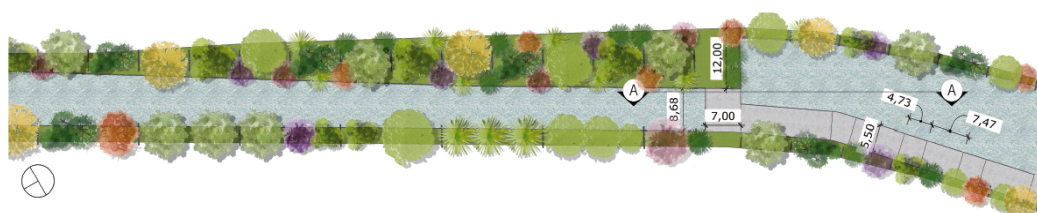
Planta Layout Trecho 01. Fonte: Autoral, 2022.
